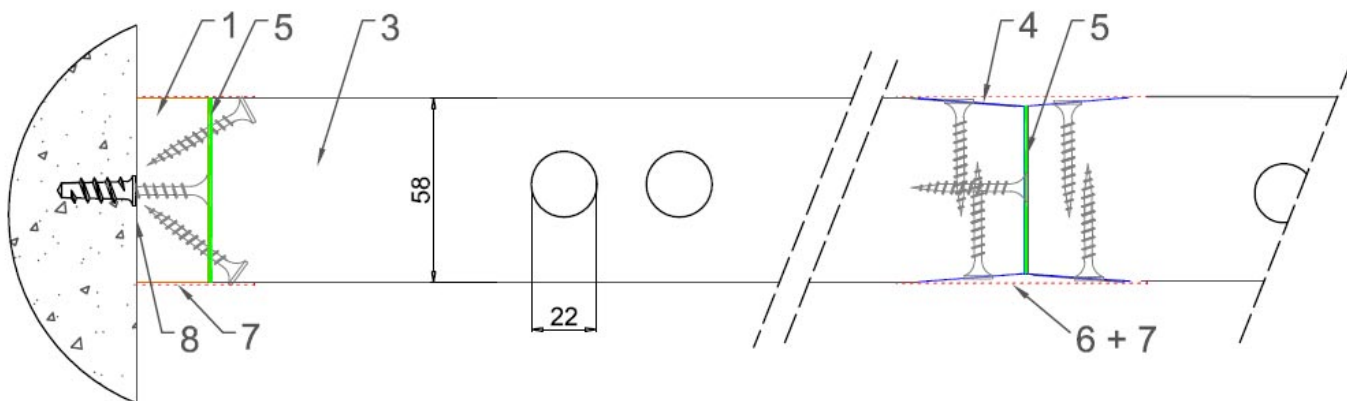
Coupe horizontale illustrant le mode de fixation des panneaux sur leurs rives verticales
